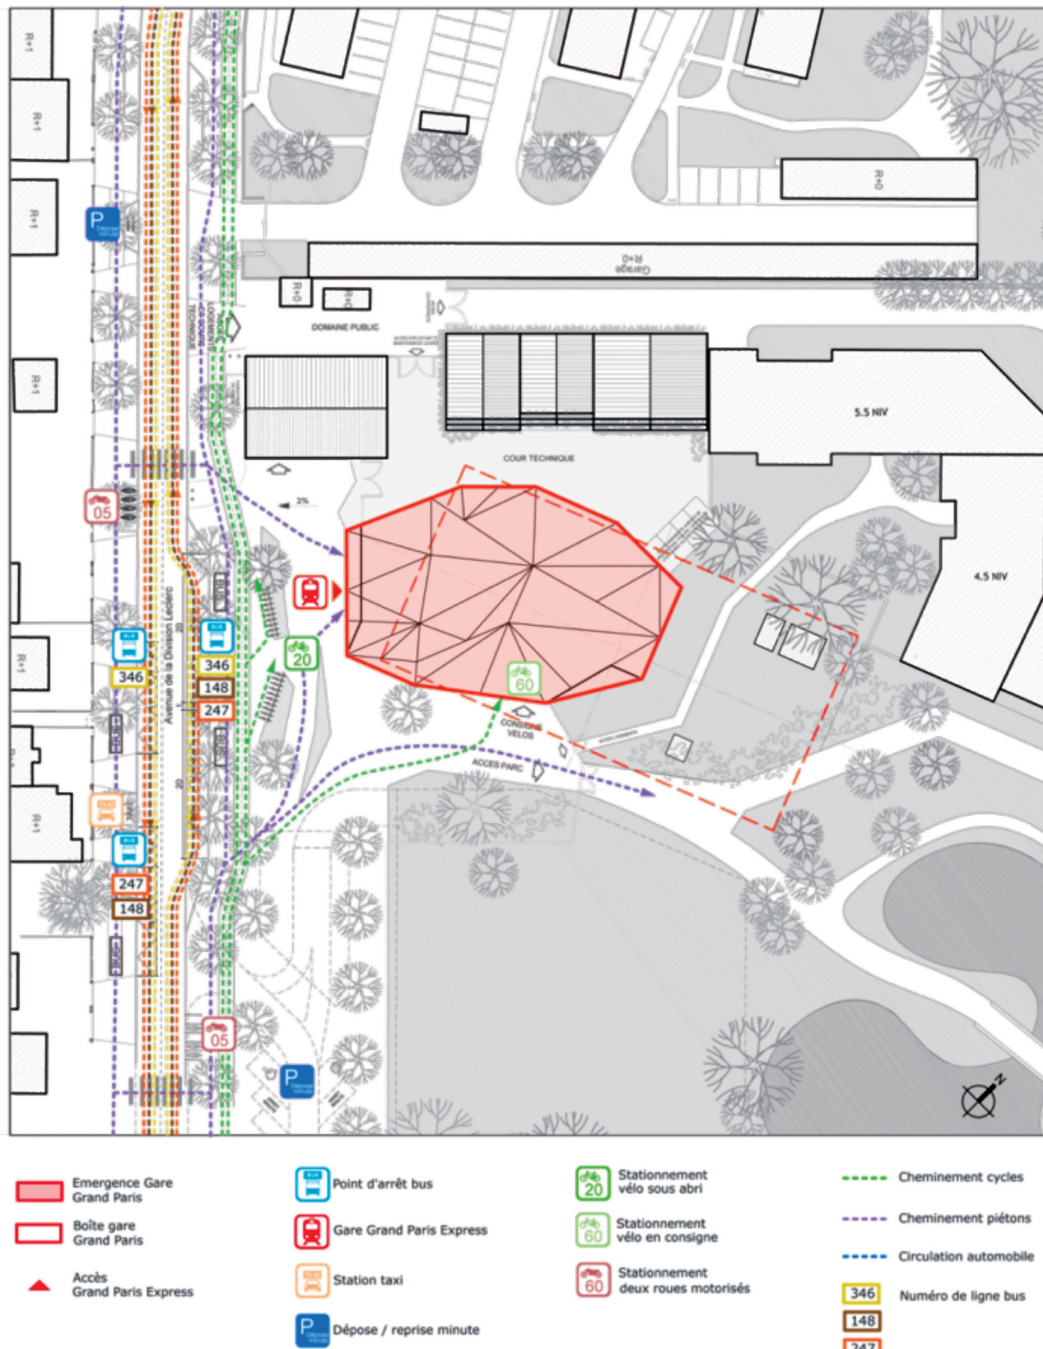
Plan masse de la gare associé au projet urbain de la ville
